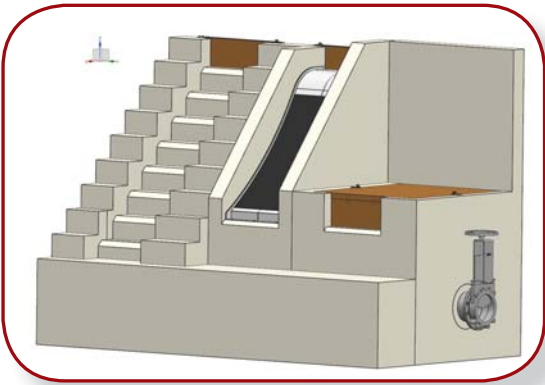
Водоприемное сооружение (комплект опалубки для возведения бетонного резервуара)
